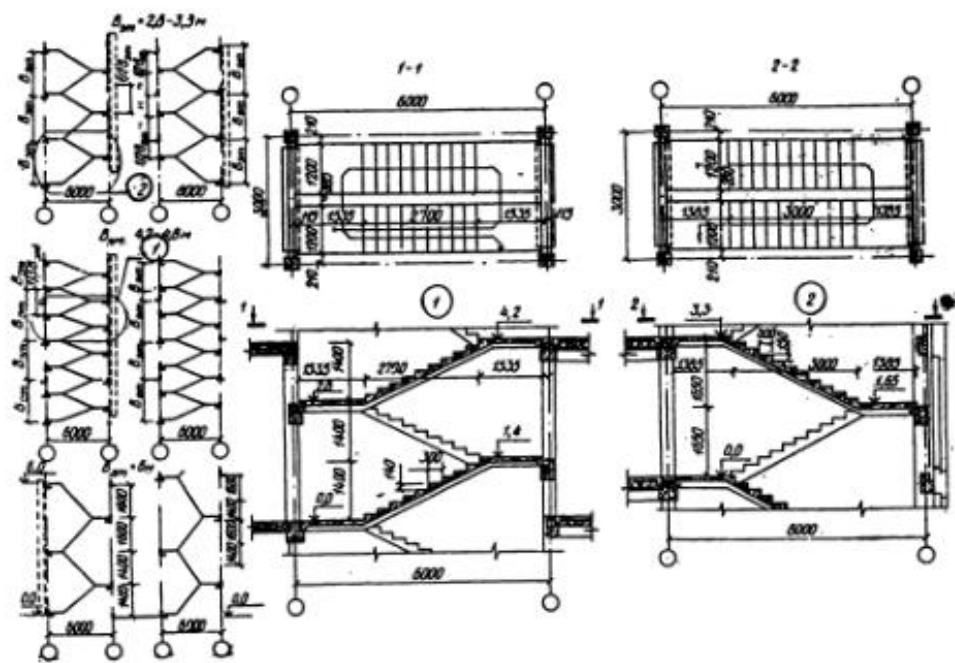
Примеры монтажных схем лестничных клеток в каркасно-панельных зданиях
